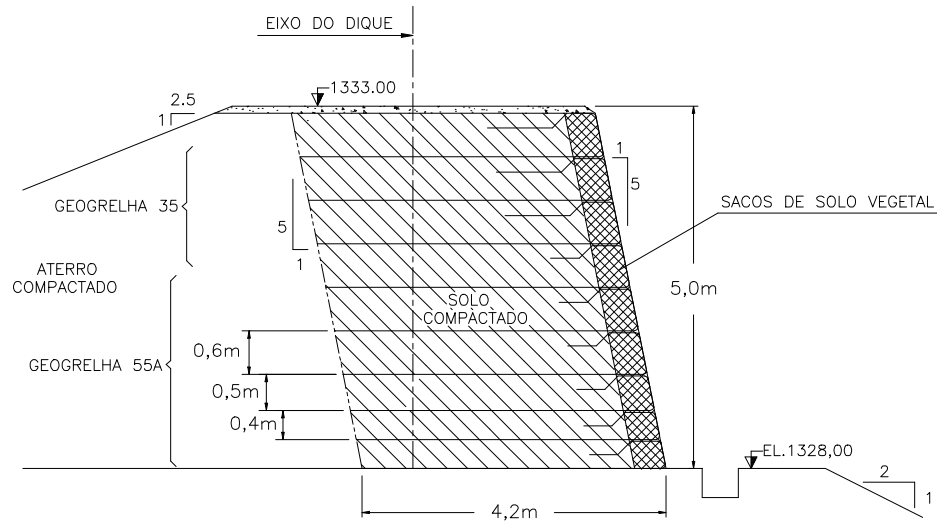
Detalhe da seção transversal típica do muro de solo reforçado.
